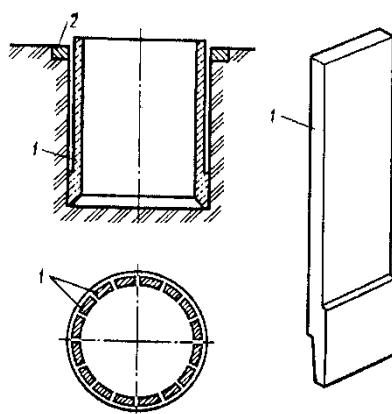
Сборный опускающий колодец из вертикальных панелей:
